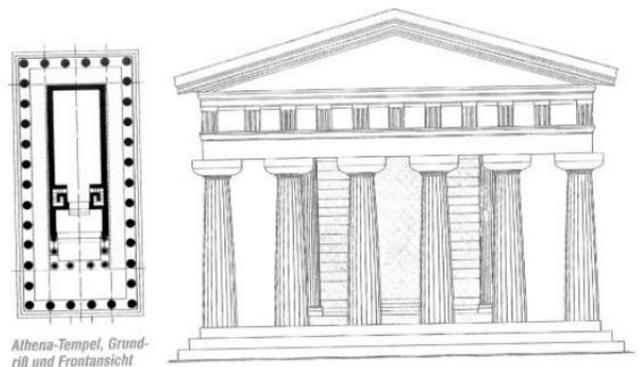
Grundriss und Frontalansicht Athene-Tempel
